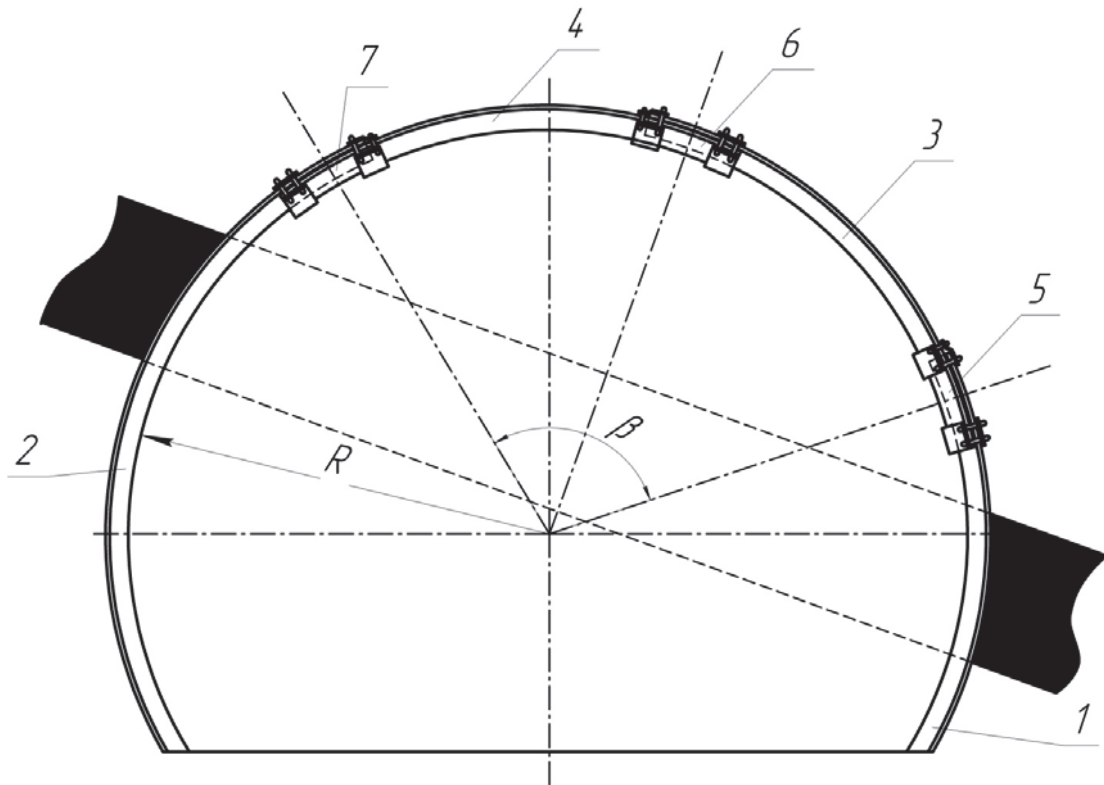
Предлагаемая конструкция крепи: 1 и 2 – стойки крепи; 3 – элемент составного верхняка; 4 – верхняк; 5, 6 и 7 – узлы соединения несущих элементов
